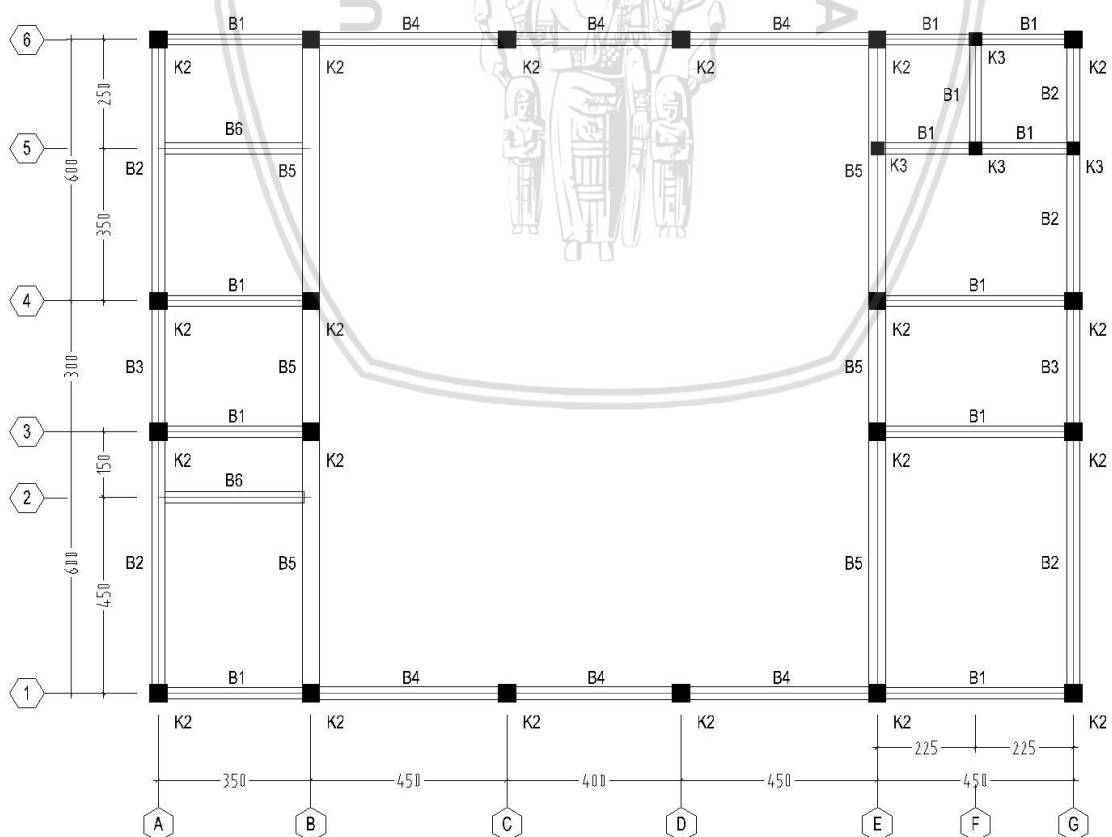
Pemodelan Denah Balok-Kolom Lantai 2-4 (Level 2-4)
